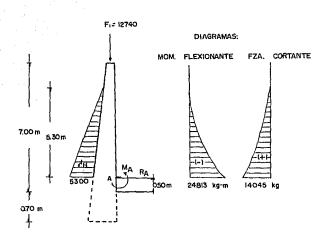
ESFUERZOS EN EL MURO DEL CANAL DESARENADOR
